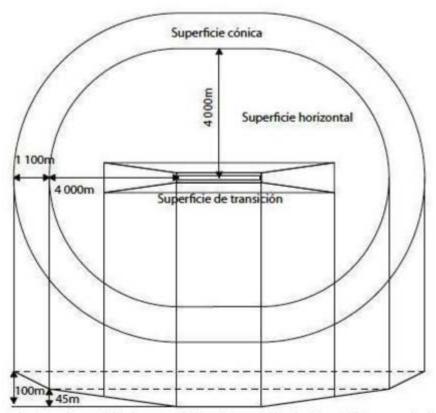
Vista en planta y de perfil de las superficies de transición, horizontal interna y cónica. Fuente: UNAM.
